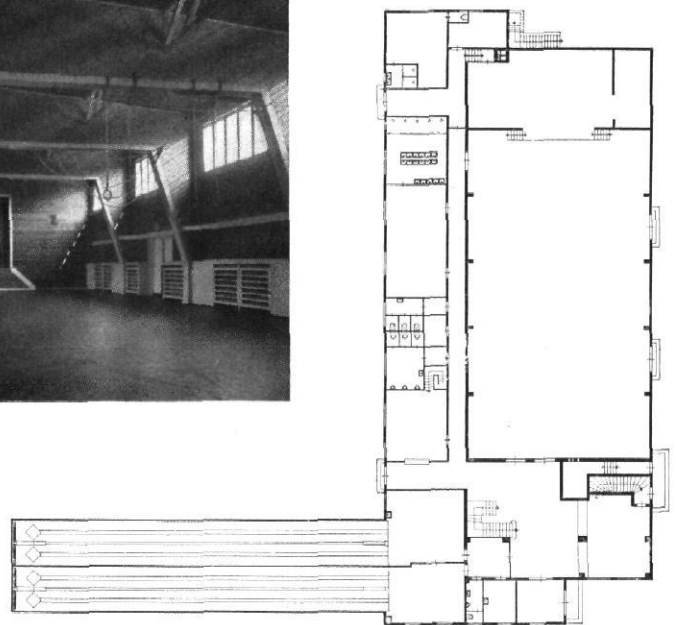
/ Turnhalle in Siemensstadt / Straßenfront / Anschluß an Abb. 9
